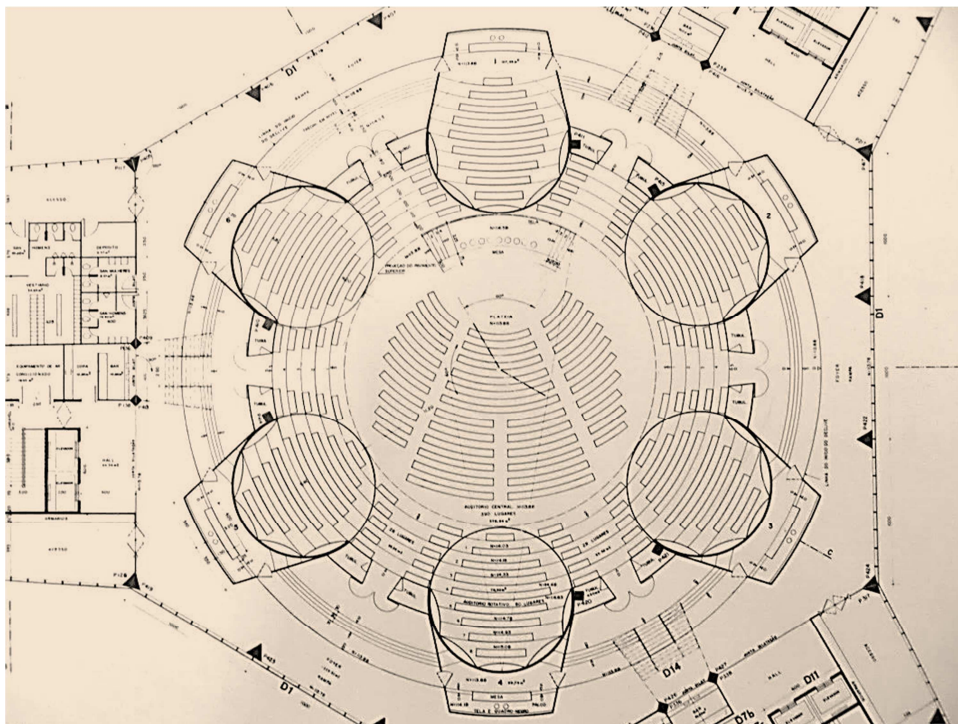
Sergio Bernardes, ESG, DF, 1970/74. Detalhe Planta 2º Pavimento (Nível + 5) Auditório Central c/ Auditórios Giratórios. Fonte: Acervo Sergio Bernardes NPD/UFRJ.
